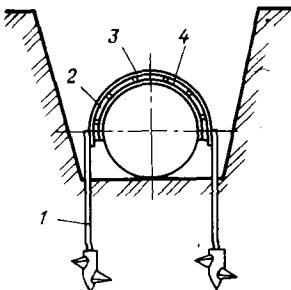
Схема закрепления трубопровода винтовым анкером:
